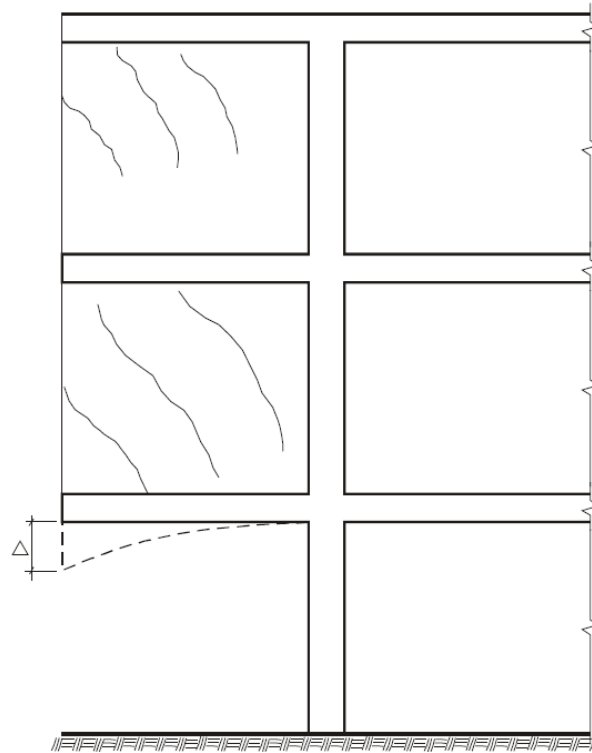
Fissuras inclinadas em alvenaria originadas pela flexão de um balanço
